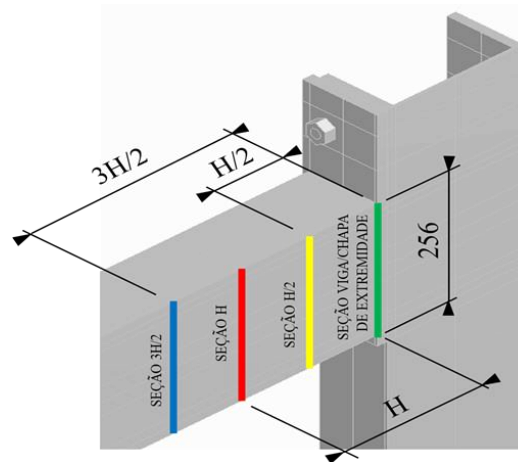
Posição das seções transversais verticais da alma da viga.
